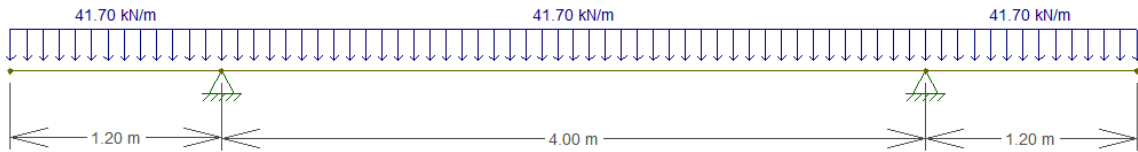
Sistema estático e carregamento nas vigas secundárias externas
